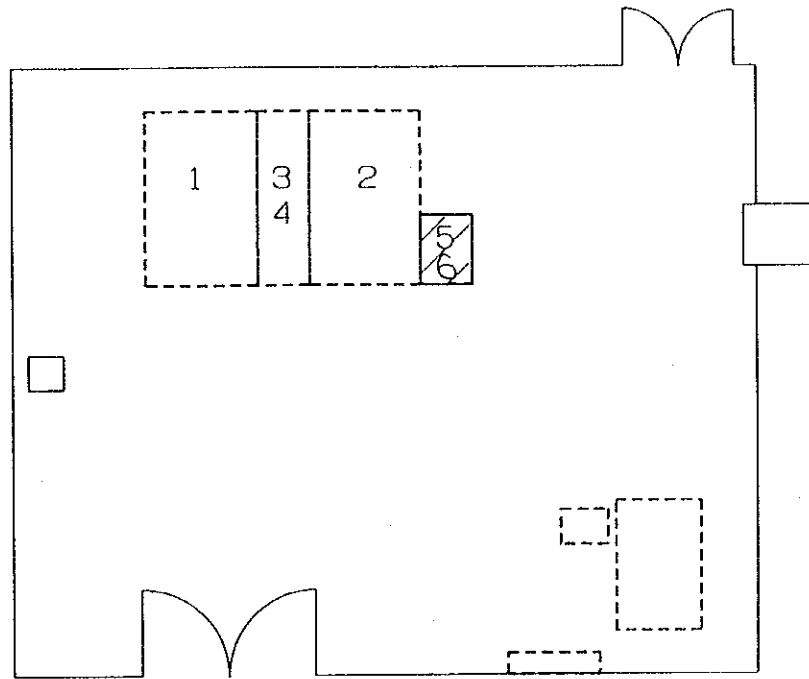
マシンギニ送信所自家用発電機舎平面図
